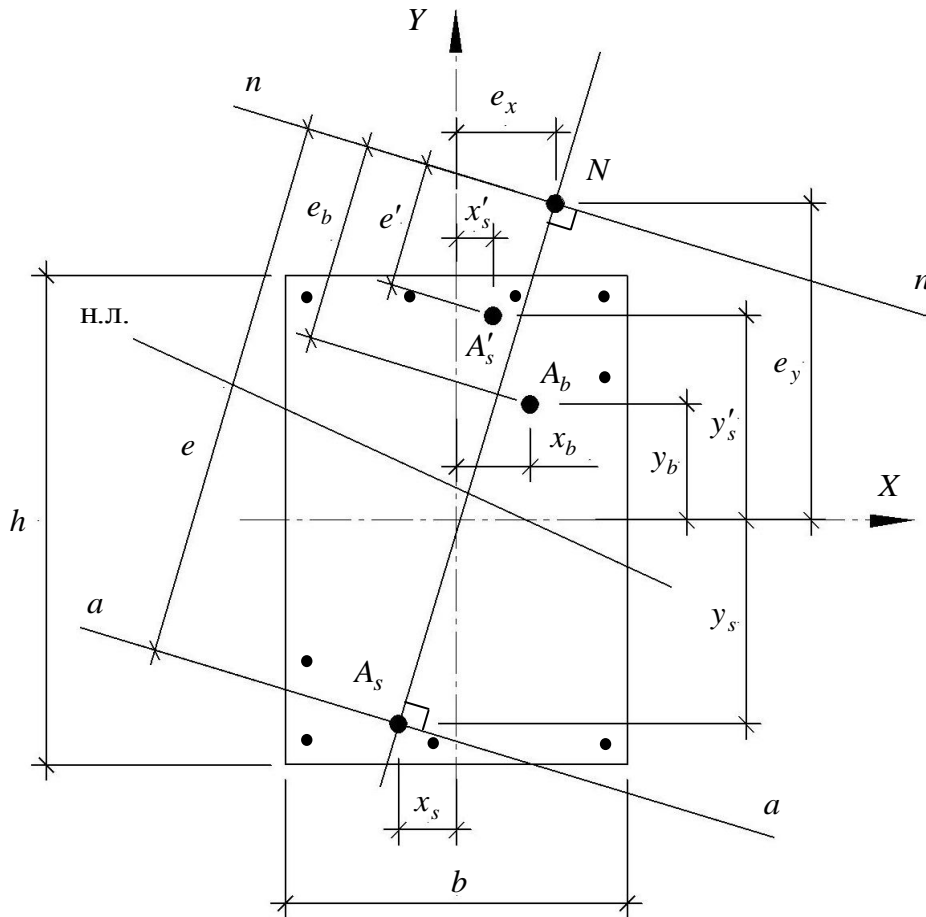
Расчетное прямоугольное сечение железобетонного элемента.
